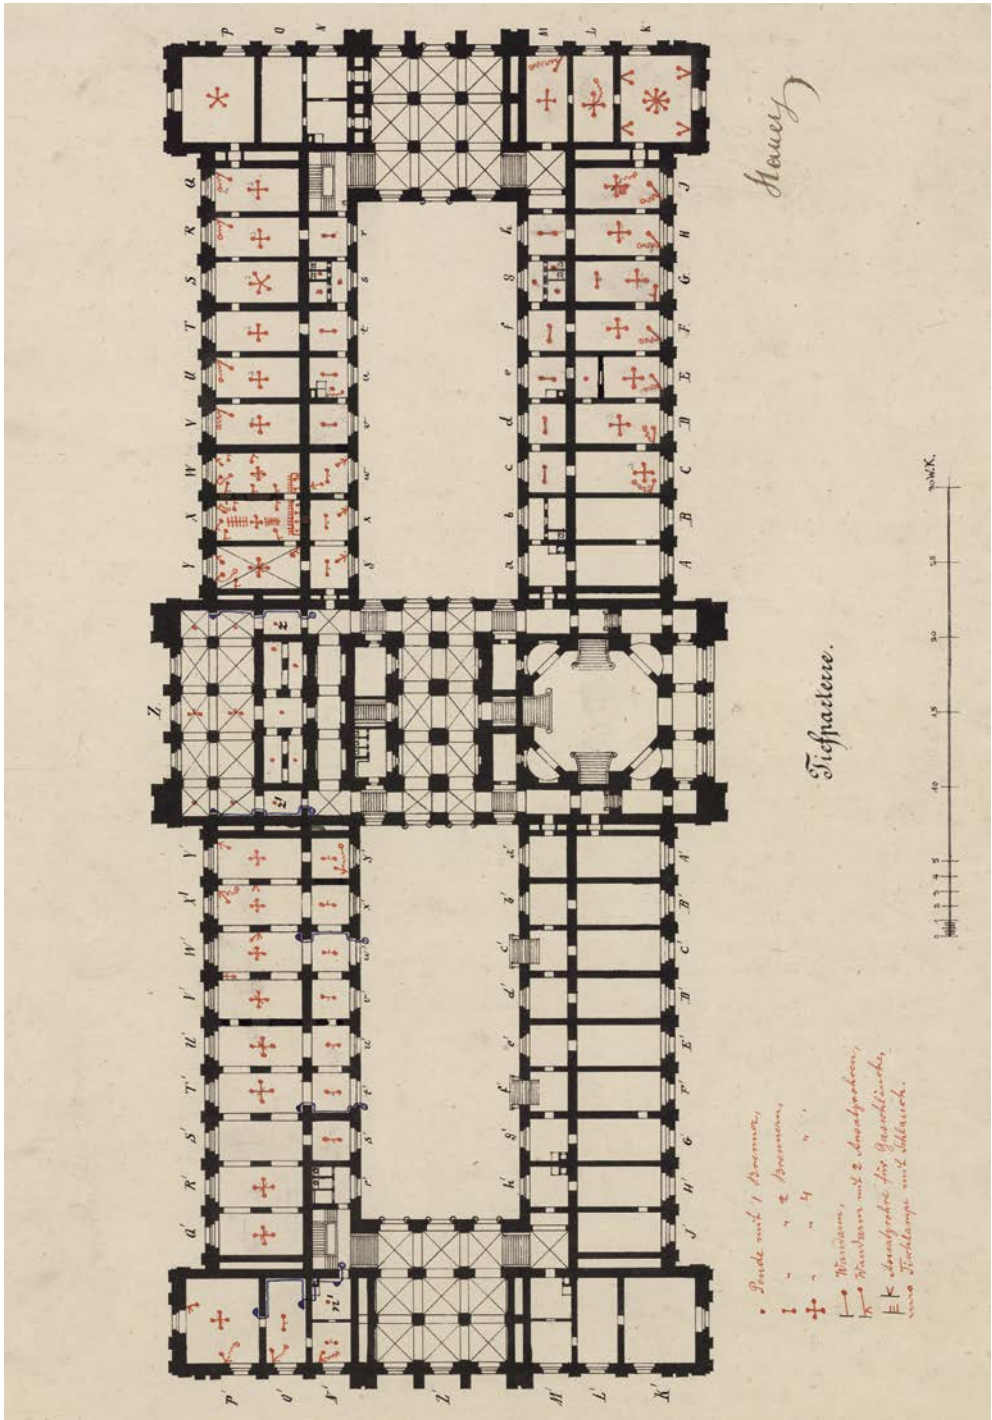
Franz von Hauer: Tiefparterre-Plan mit Gasinstallationen, undat. (vermutlich 1885), Plansammlung des Archivs für Wissenschaftsgeschichte, NHMW
